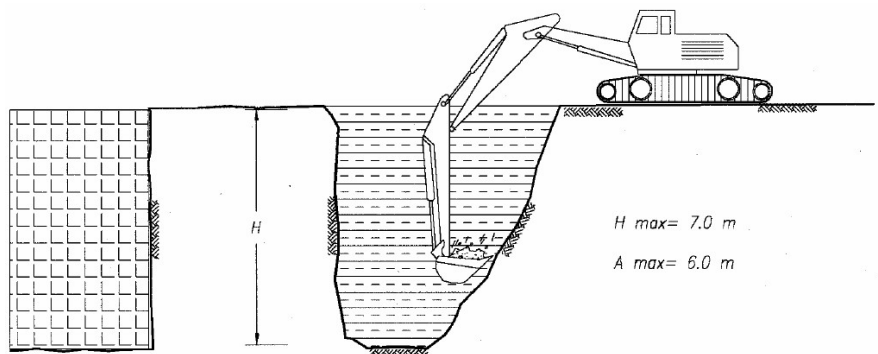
EXCAVACIÓN DE ZANJAS CON RETROEXCAVADORA
